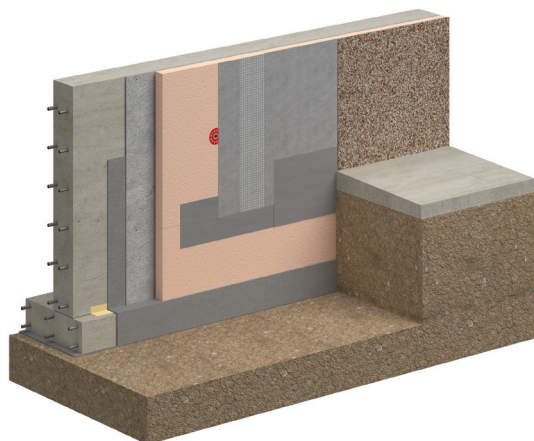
Защита ограждающих конструкций от воздействия грунтовых вод со стороны грунта
